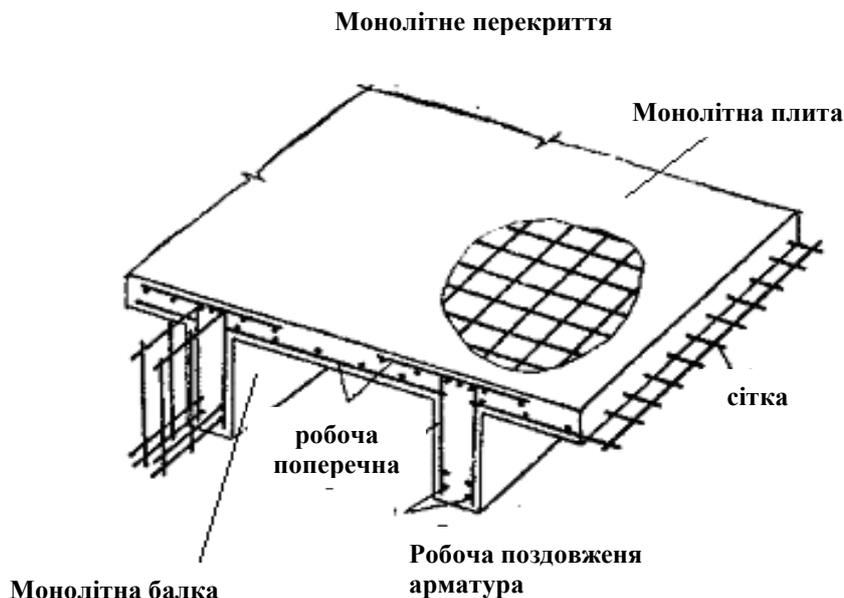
Застосування арматури в монолітному перекритті
